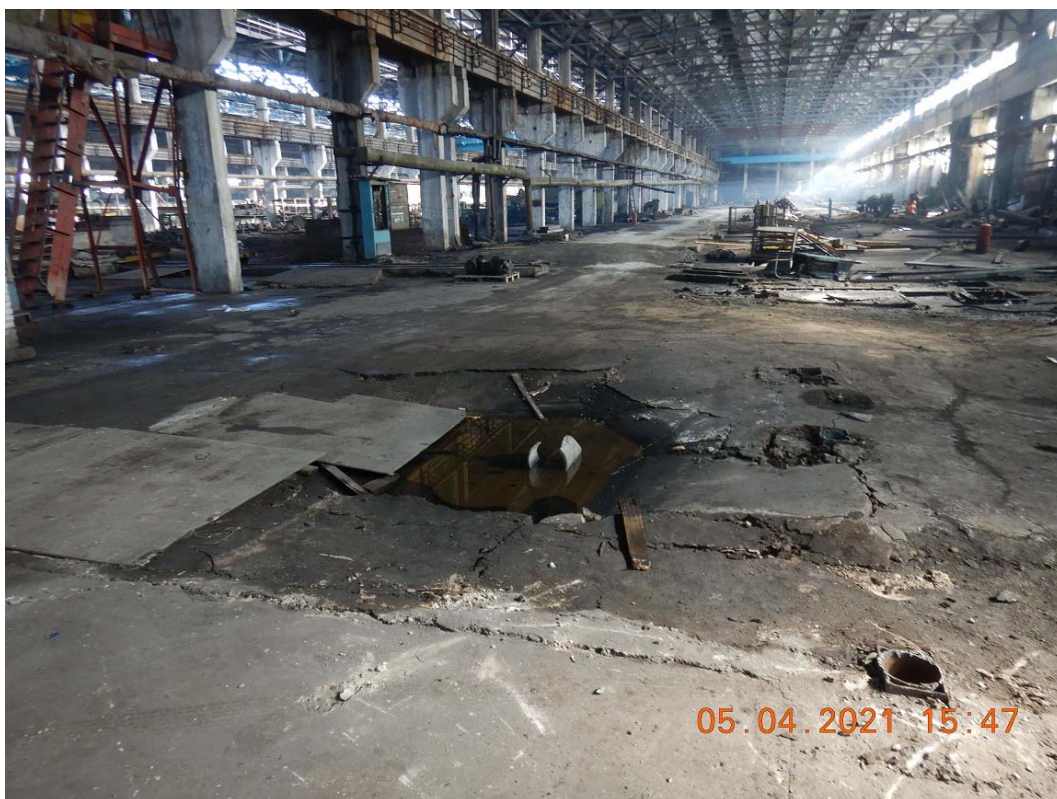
Повсеместные разрушения, проседания, множественные трещины бетонных полов в производственных пролётах здания
